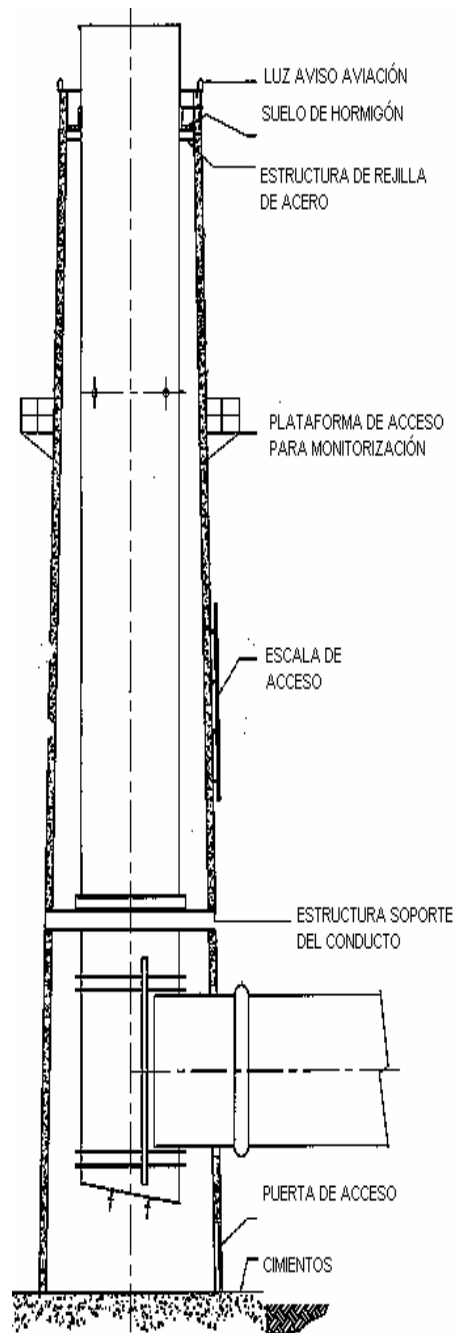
Chimenea de hormigón con conducto de acero soportado por una estructura de rejilla de acero
